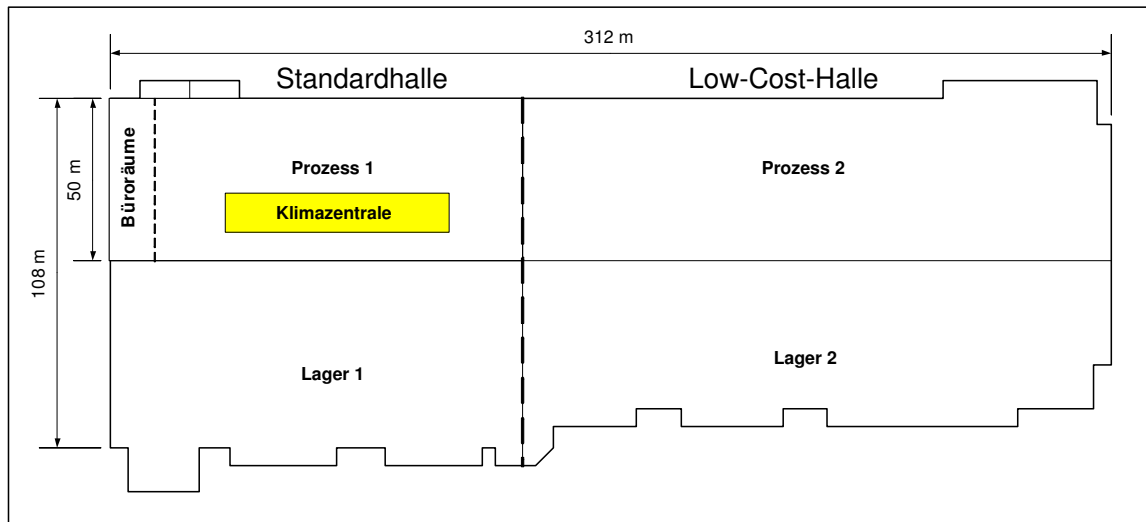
Grundriss des verwendeten Beispielobjekts
